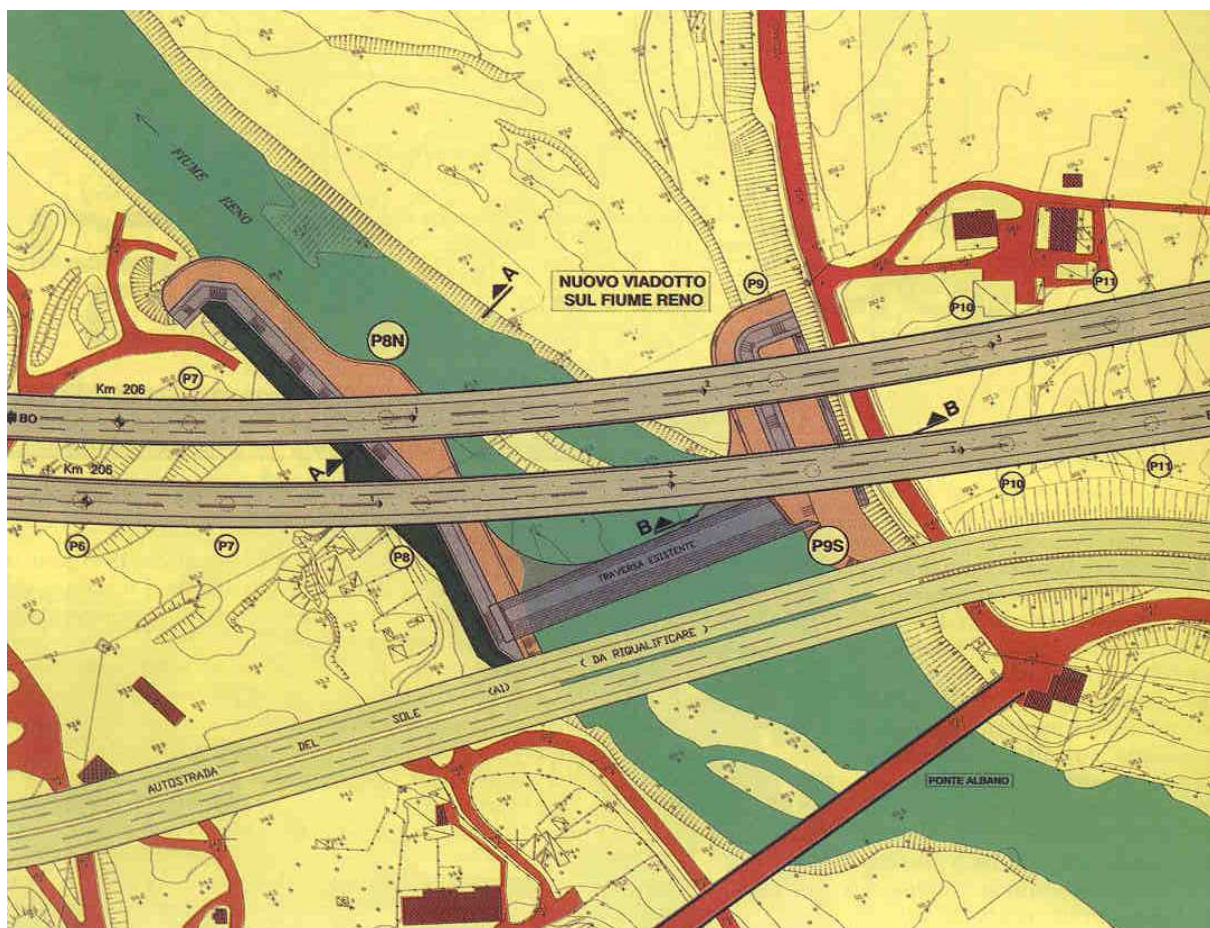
Planimetria generale degli attraversamenti e delle sistemazioni d'alveo previste.
